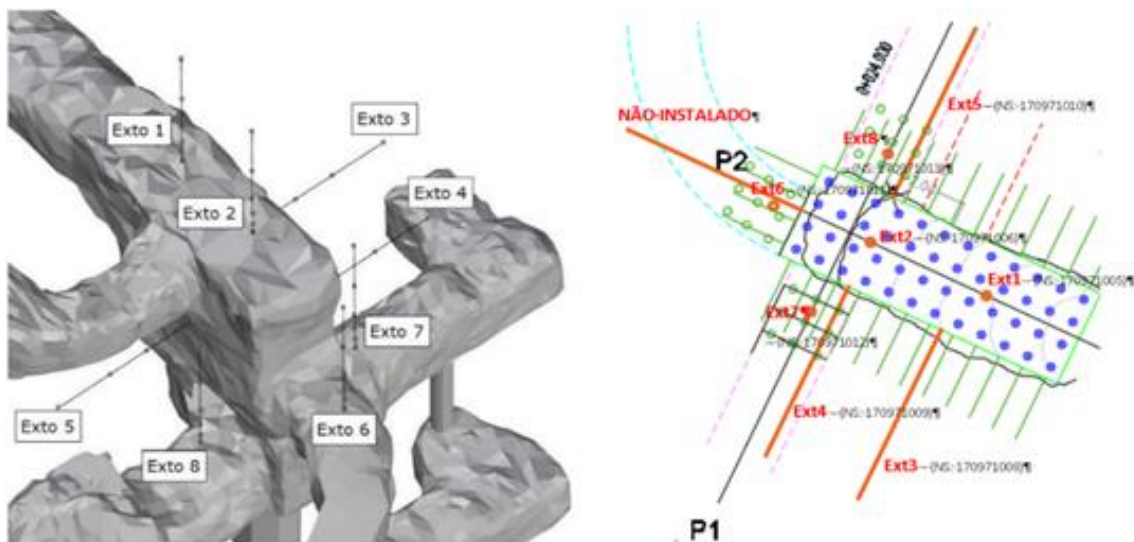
Representação dos extensómetros num modelo 3D (vista para SE) e em planta (Fonte: Lundin Mining 2019)
